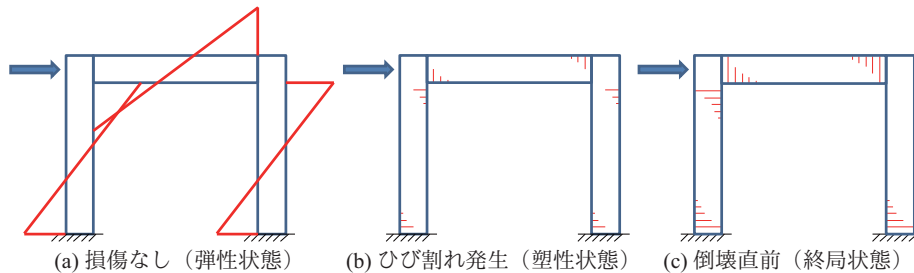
荷重による構造物の損傷（ひび割れ）状態の変化。
